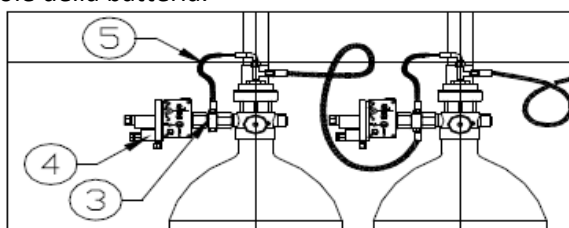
Dettaglio valvola di scarica e collettore pneumatico
